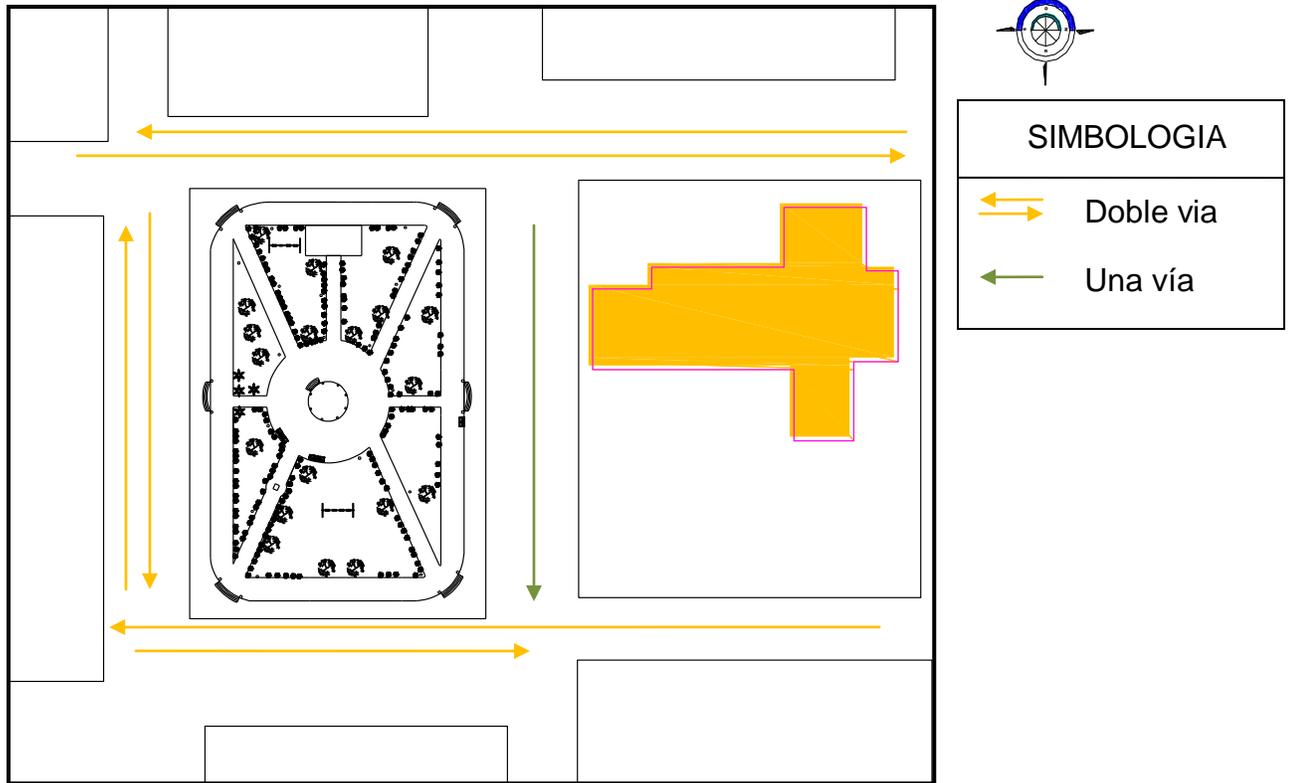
Planta del parque. Fuente: Grupo de trabajo.
